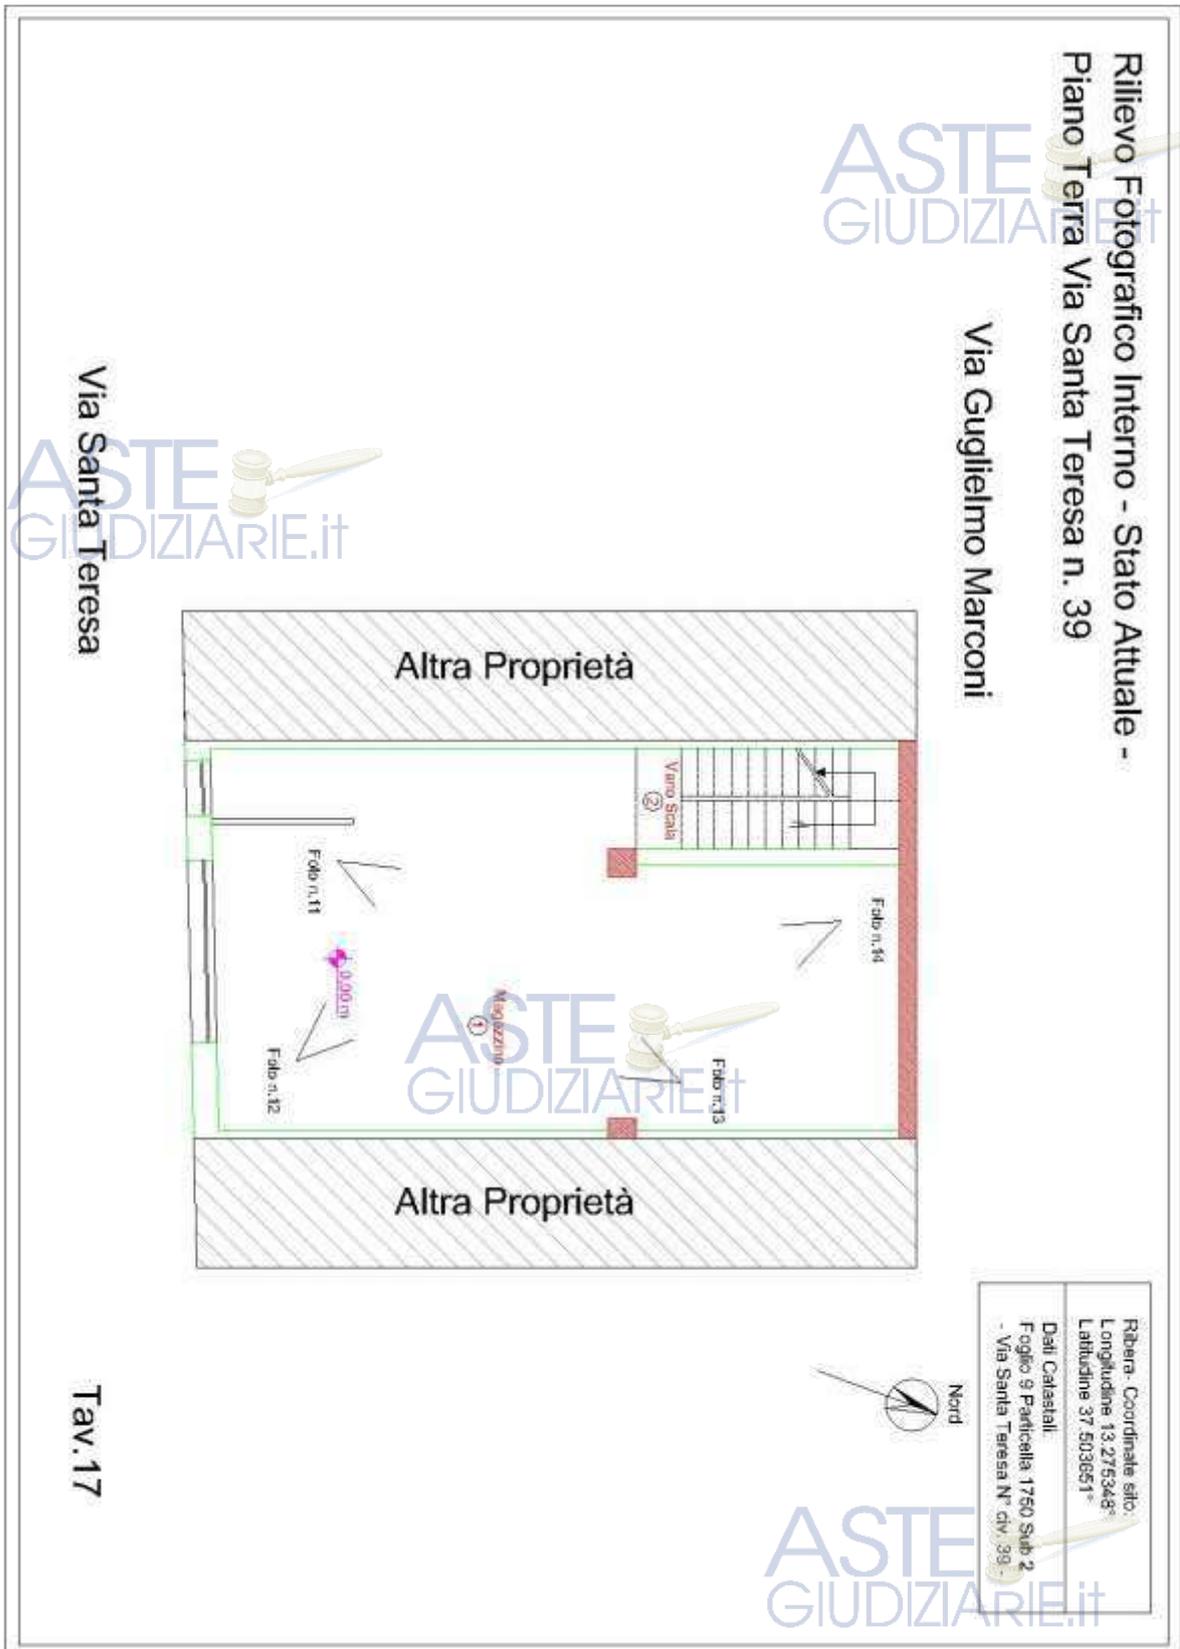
Individuazione Foto interne - Lotto 1 Immobile1.
